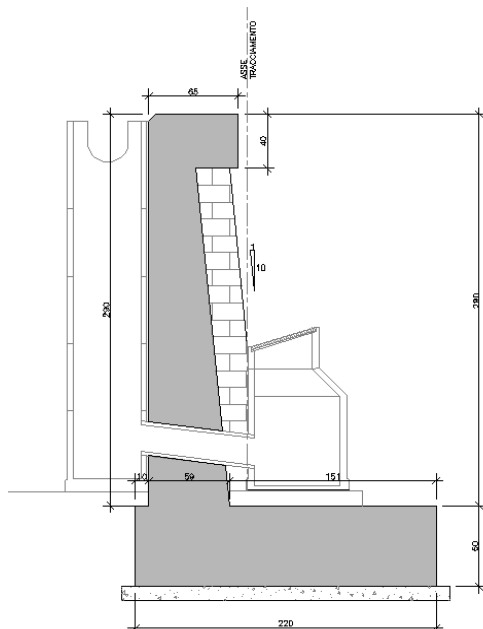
Geometria del muro M01 – Concio 11 – Sezione di verifica
